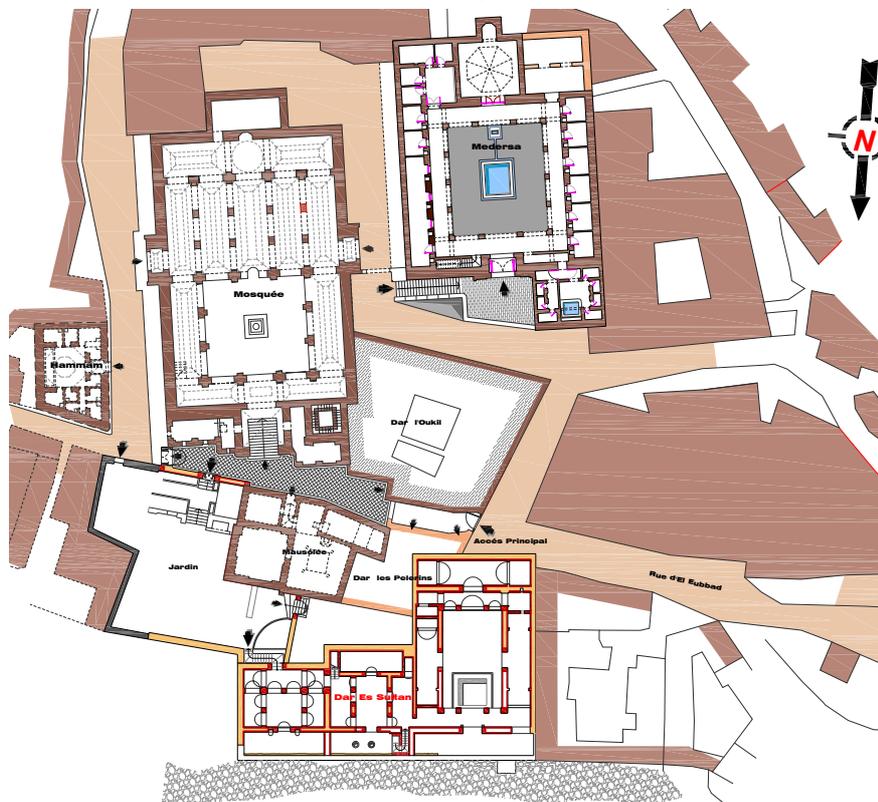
Plan de l'état des lieux, Rez De Chaussée Existant. Ech : 1/1000 Source : auteur 2014.
